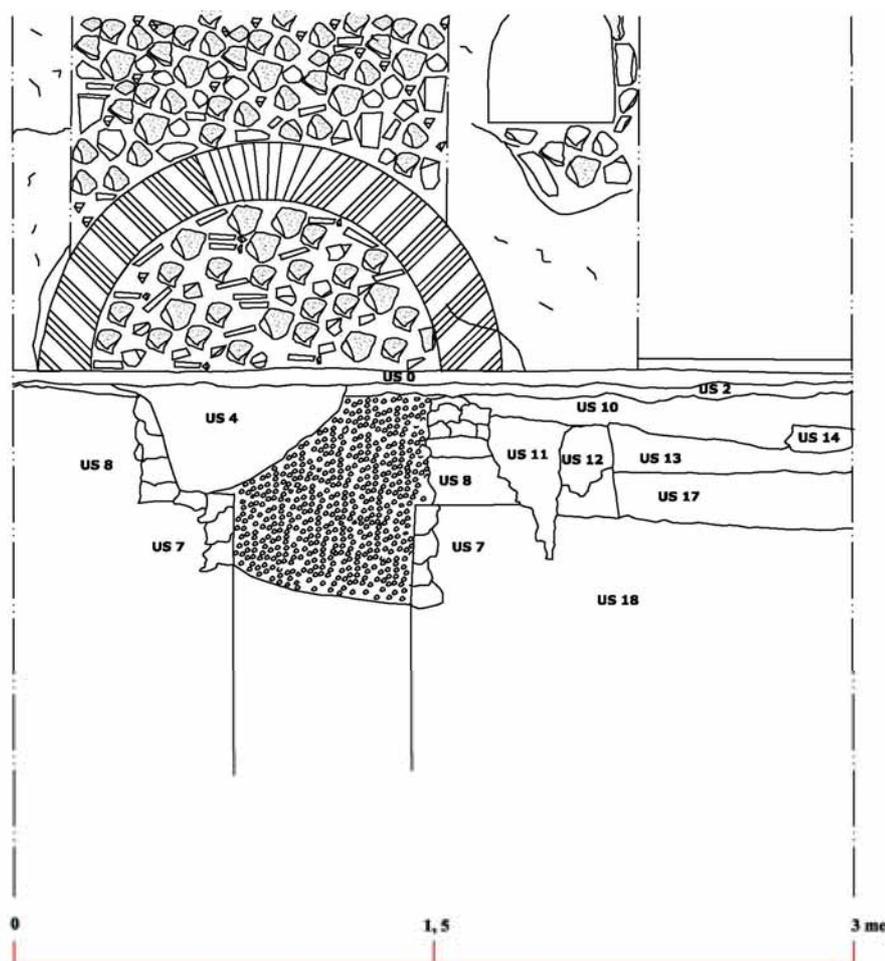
Domus IX 9, (e). Prospetto e sezione parete E dello scavo del marciapiede.
